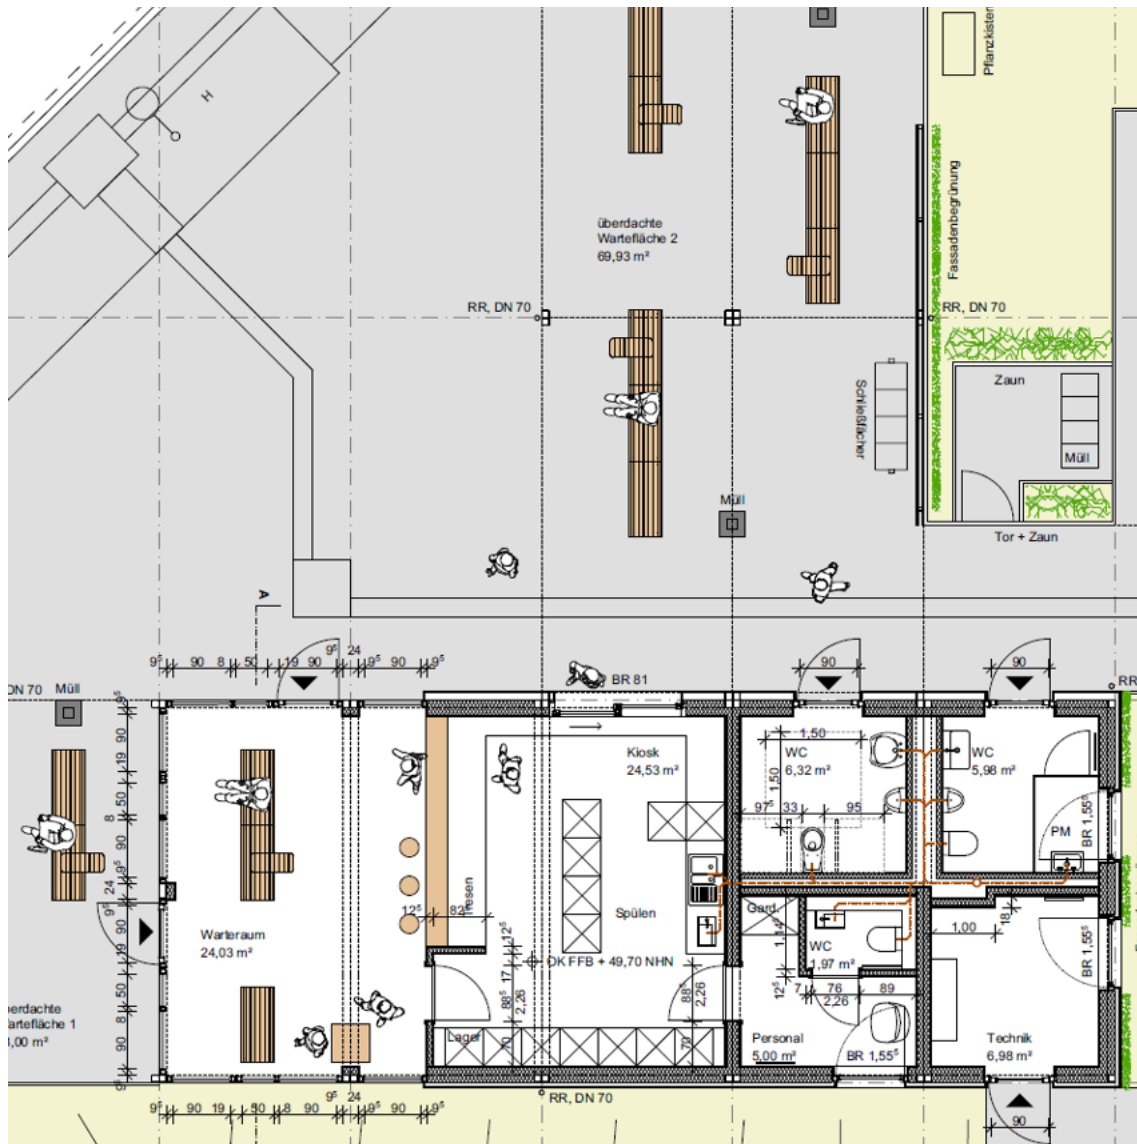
Grundriss am Beispiel der Plushaltestelle Bad Segeberg, Architekt Reichwald GmbH
